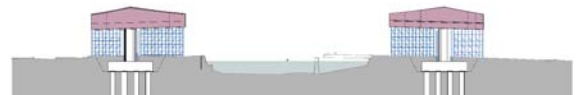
上部工標準断面図（左：P1 部 右：桁端部）
